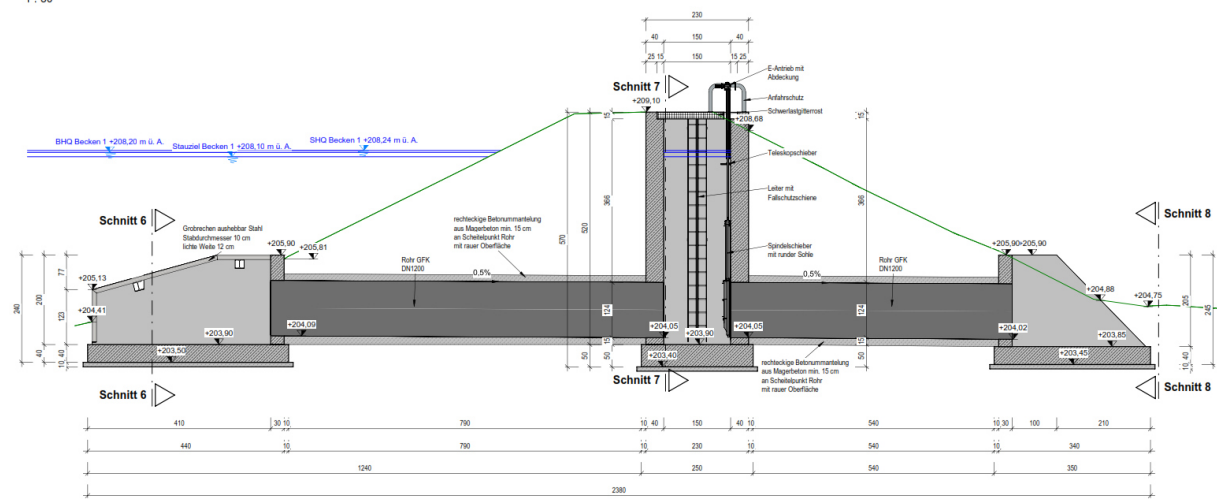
Schnitt durch das Auslaufbauwerk; aus [12]
